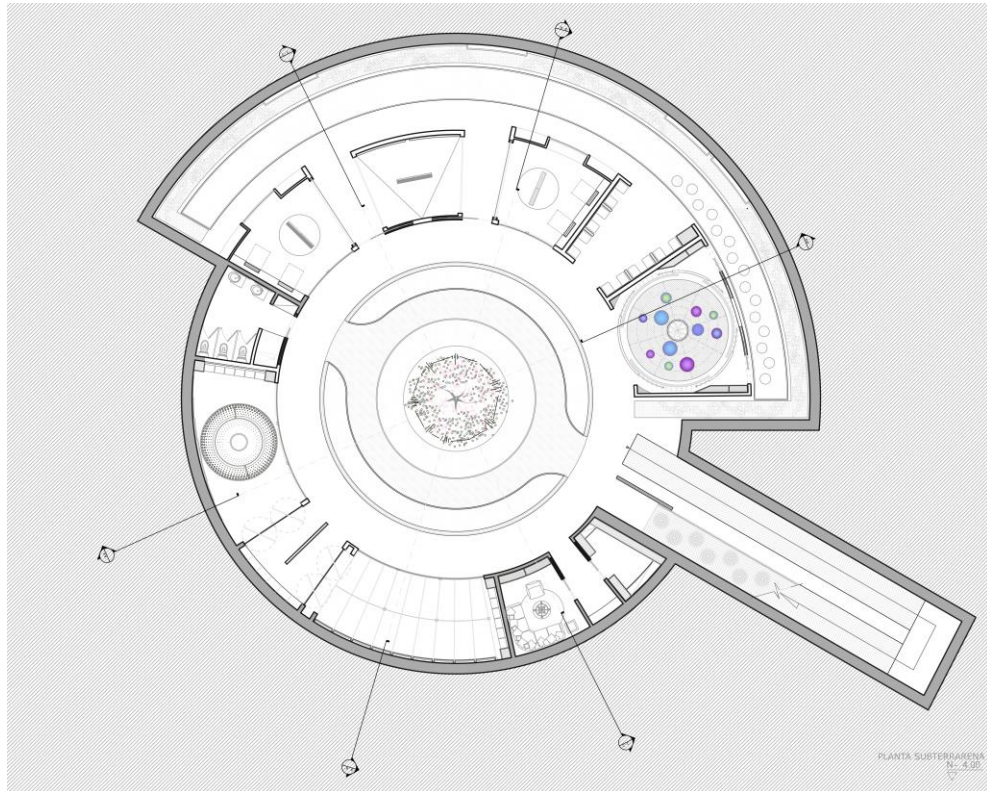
Planta General Subterráneo N -4.0. Esquema realizado por la autora
